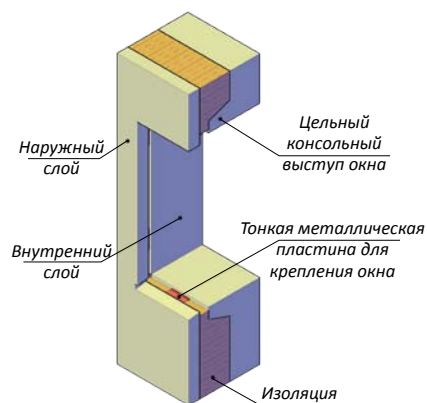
Цельный консольный выступ для опоры окон и дверей.
